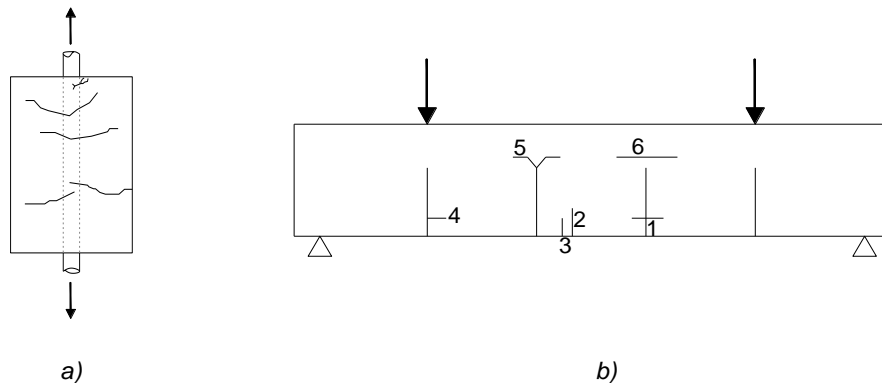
Agrietamiento presentado en: a) un elemento sujeto a tensión; b) un elemento sujeto a flexión; 1: grietas primarias, 2: grietas secundarias, 3: grietas secundarias hasta la altura del refuerzo, 4: grietas longitudinales, 5: grietas primarias divididas en dos ramas, 6: grietas horizontales a la altura del eje neutro¹⁷⁰.
